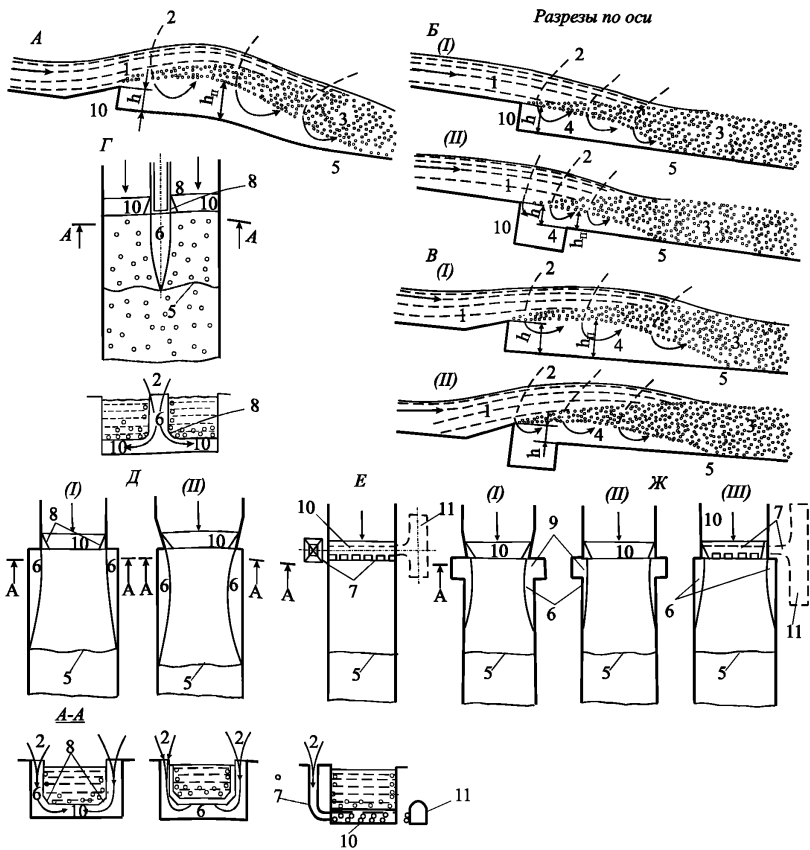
Схемы аэраторов и устройств для подвода воздуха;
